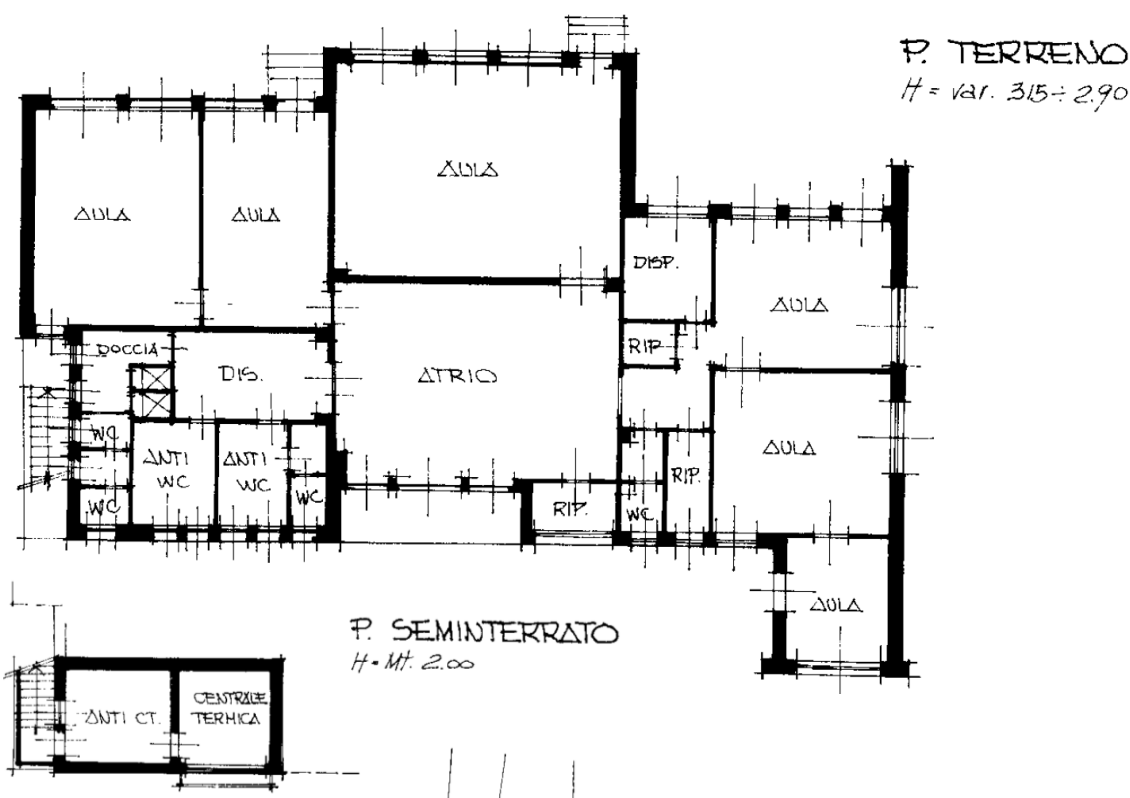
Pianta piano terra e seminterrato della scuola dell'Infanzia
